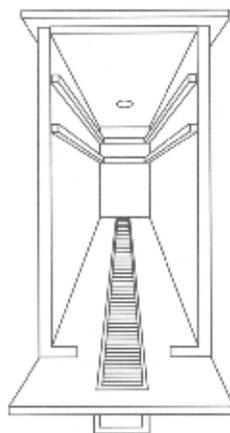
Planta de outro defumador de alvenaria.
